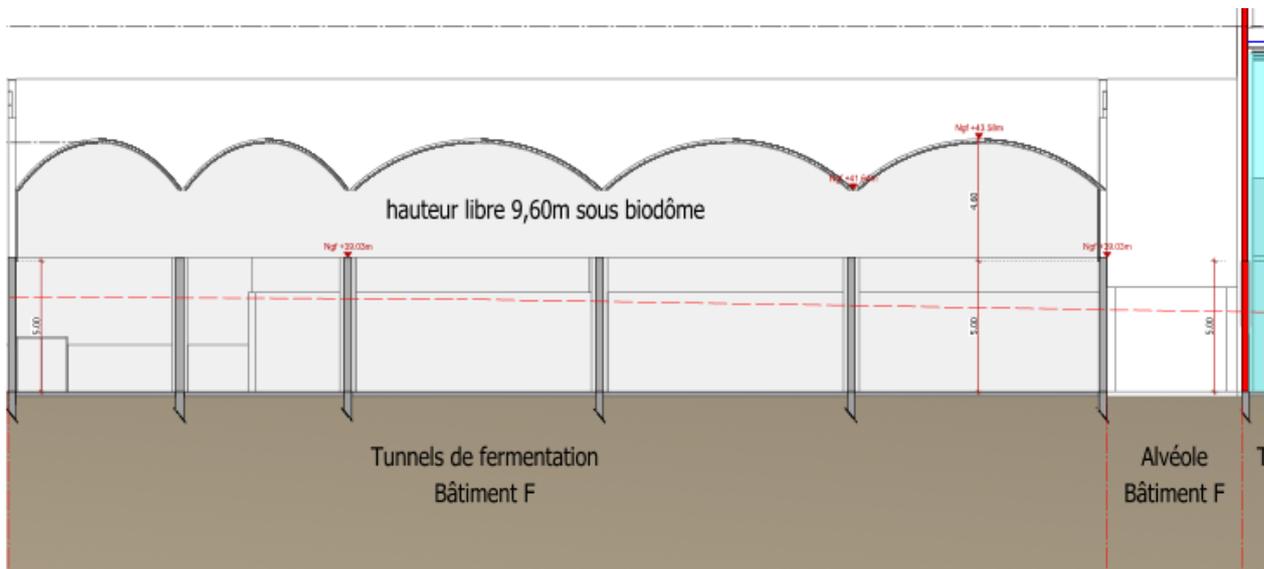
Façade des tunnels de fermentation et de stabilisation
